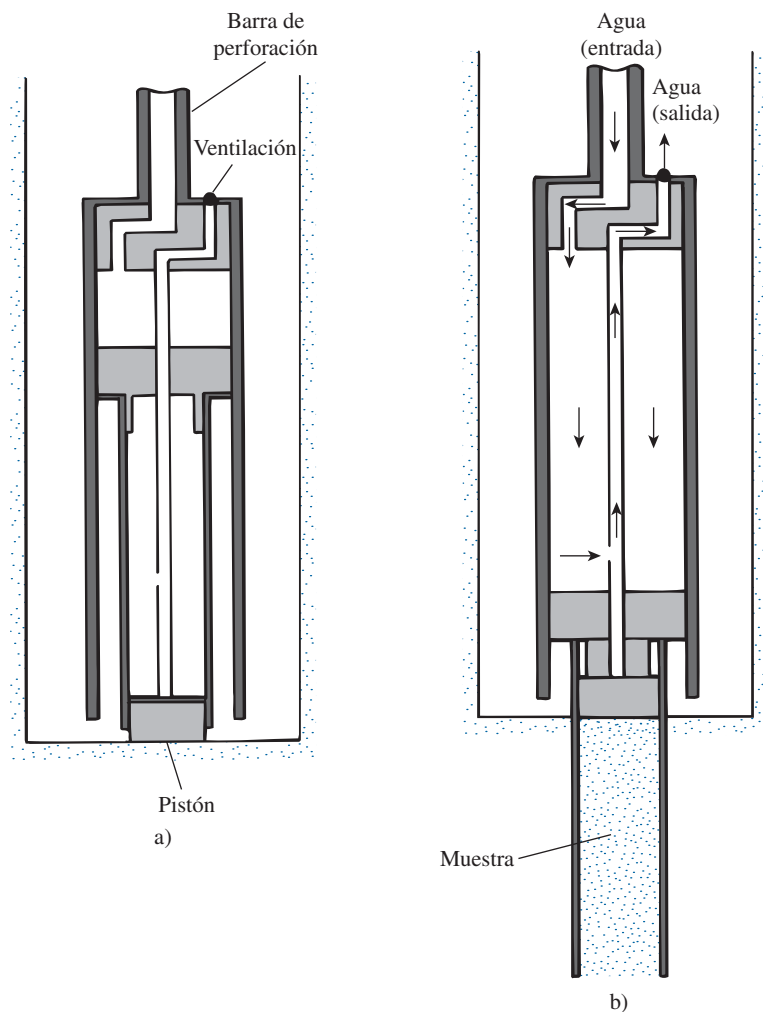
Muestreador de pistón: a) muestreador en el fondo de la excavación, b) tubo hincado hidráulicamente en el suelo.
